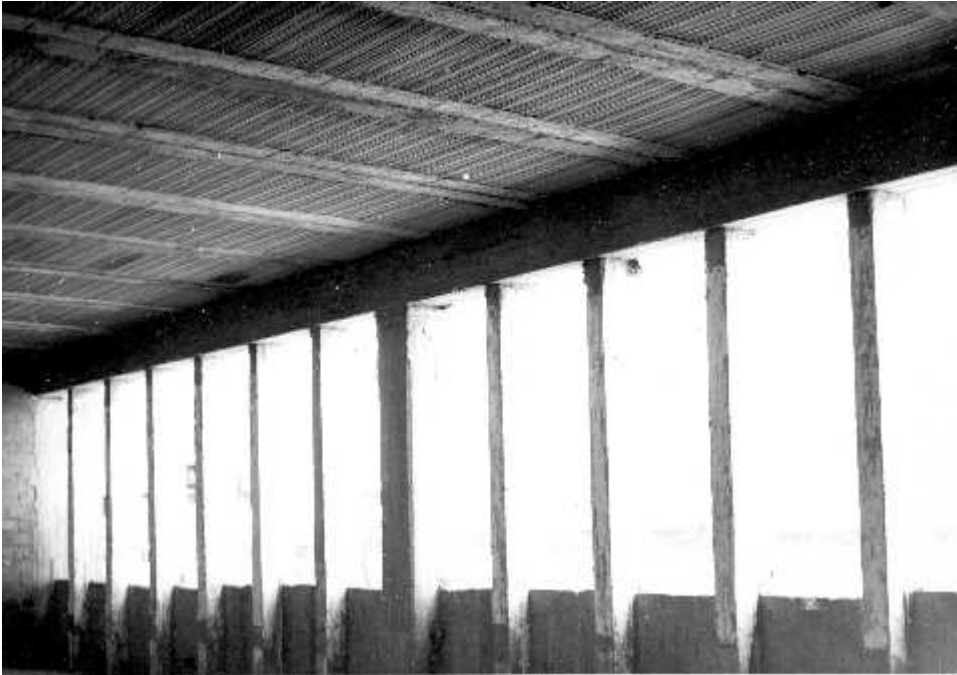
ealizzazione della struttura in pilastri e pilastrini, vista interna.
